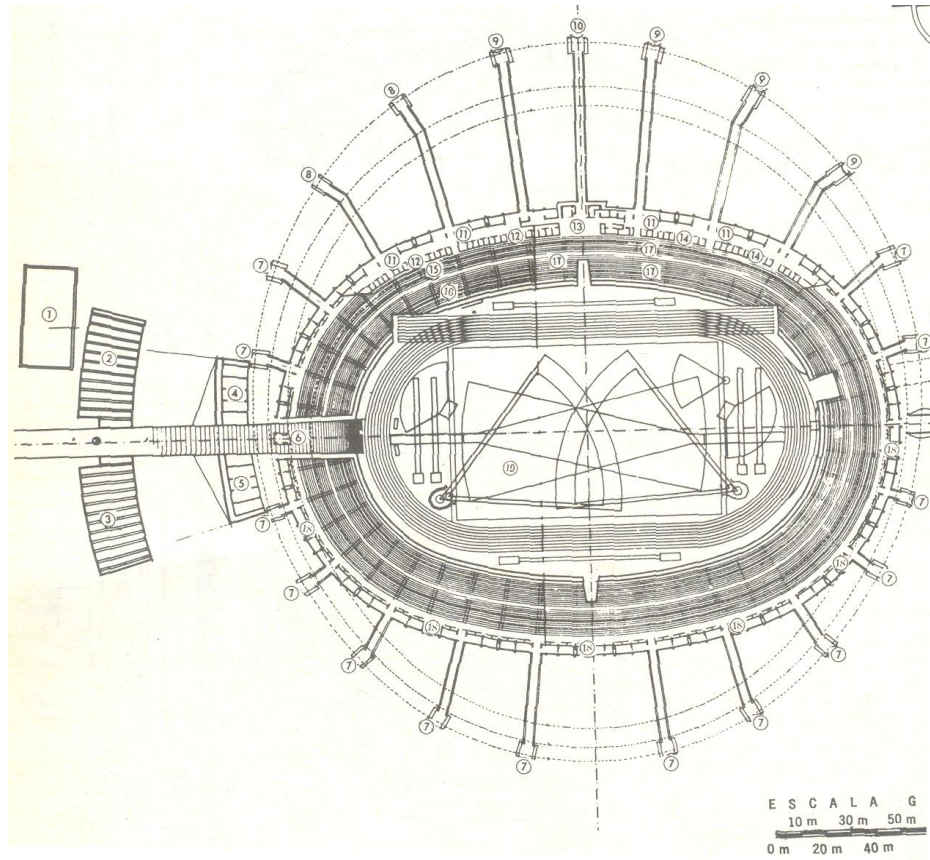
Estadio Olímpico de CU. Planta a nivel de palco.
